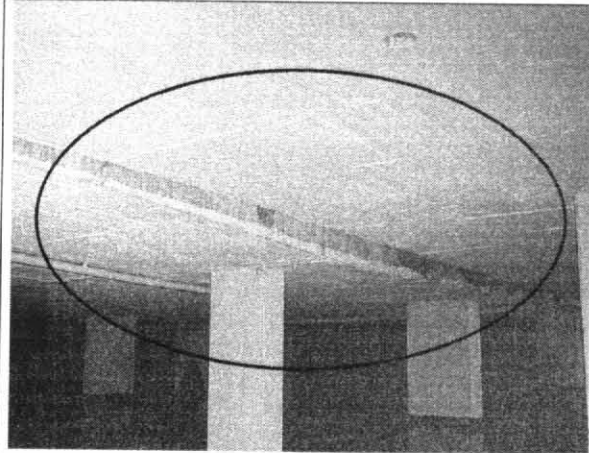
Diferencia de asentamiento, vista desde la zona parqueaderos de sótano.
